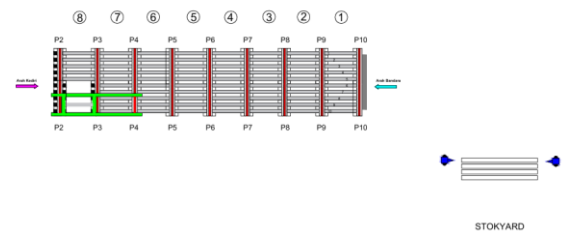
Urutan Pelaksanaan Erection PCI Girder (P10 - P9)
